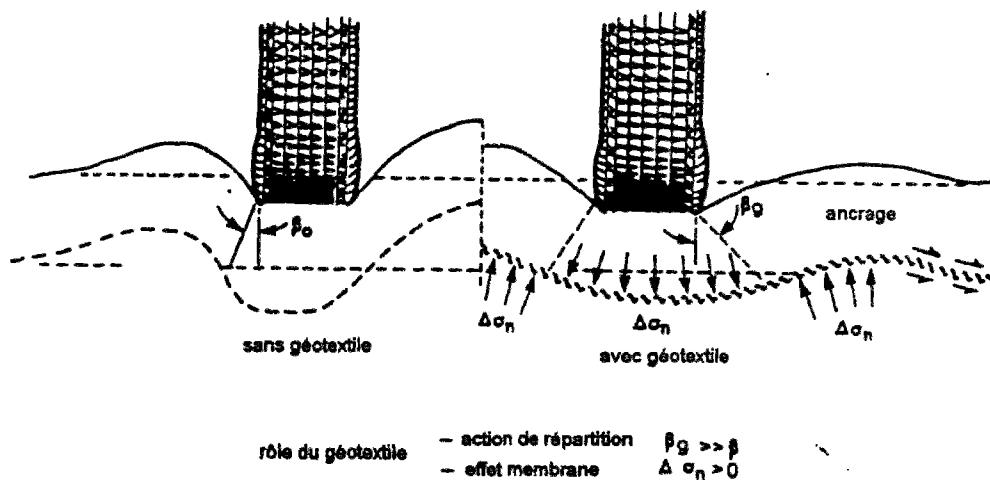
Mécanisme du renforcement dans une chaussée non revêtue (OECD, 1991)
